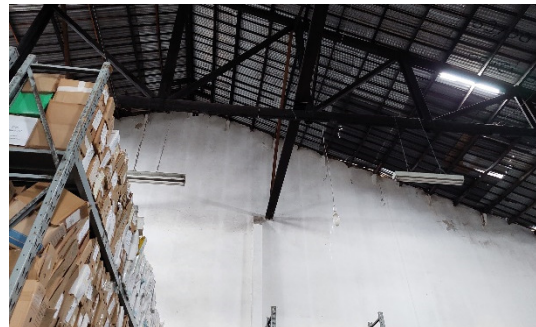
Fechamento dos fundos do pavilhão com desgaste da pintura.
